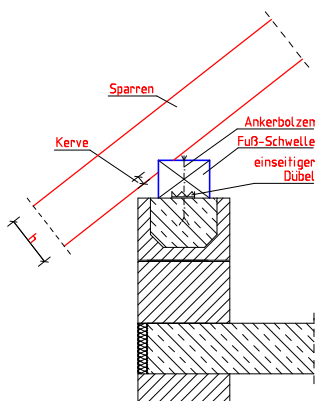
Fußschwelle ohne Dremel und Dübel besonderer Bauart
